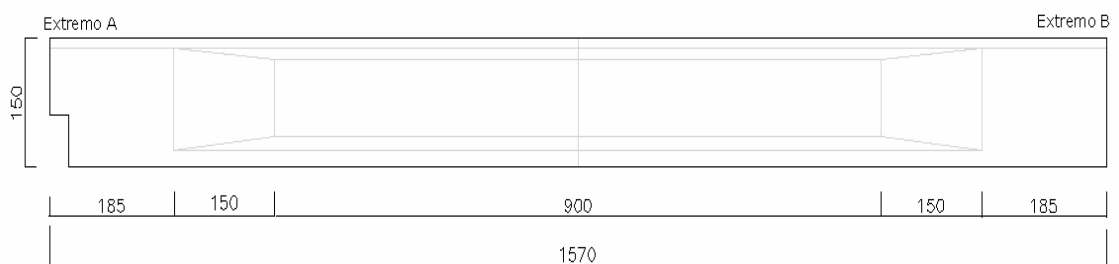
Alçado da viga pré-fabricada instrumentada (dimensões em cm)
